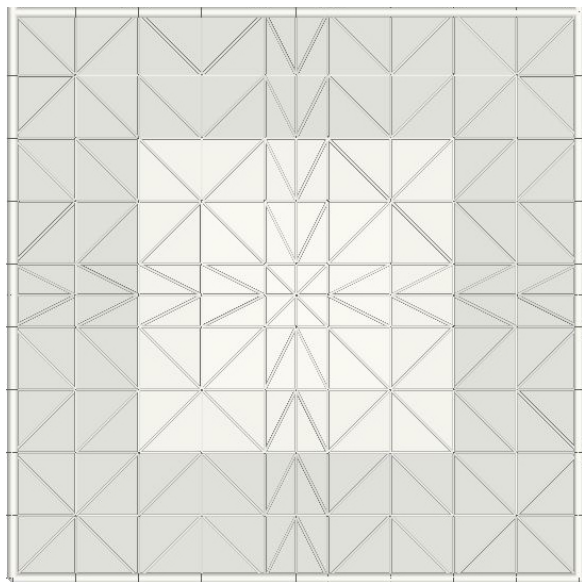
Modelo 3D | Detalle de la cubierta
